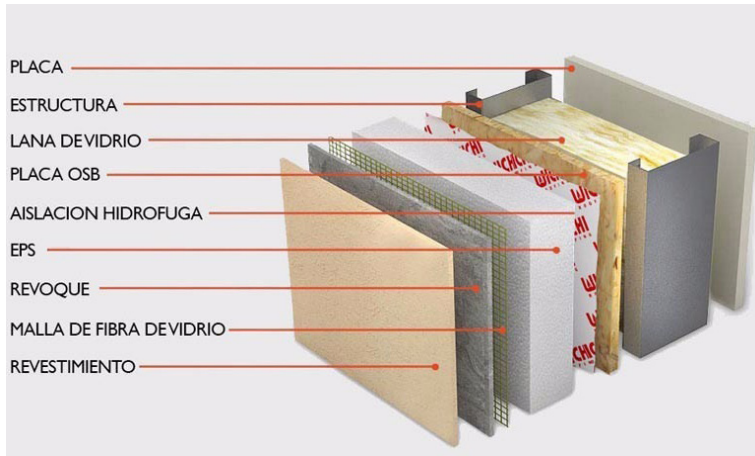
Capas que componen un panel de Steel Frame con el exterior en la parte izquierda.
